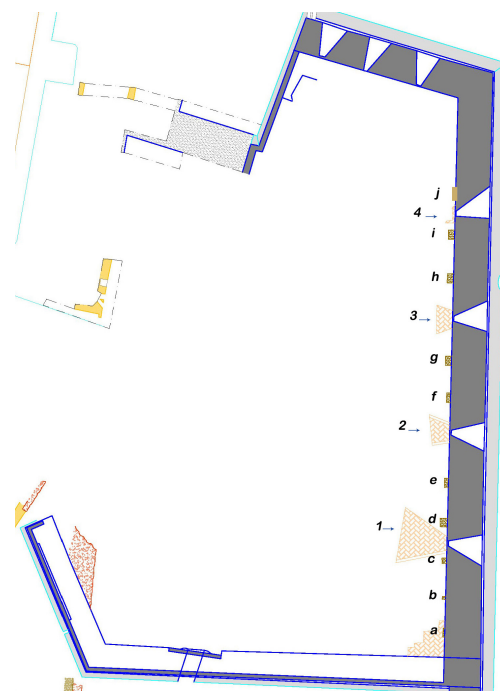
Planimetría con la división de la zona de intervención en 3 Sectores (Autor: Josep M^a Puche-ICAC).
